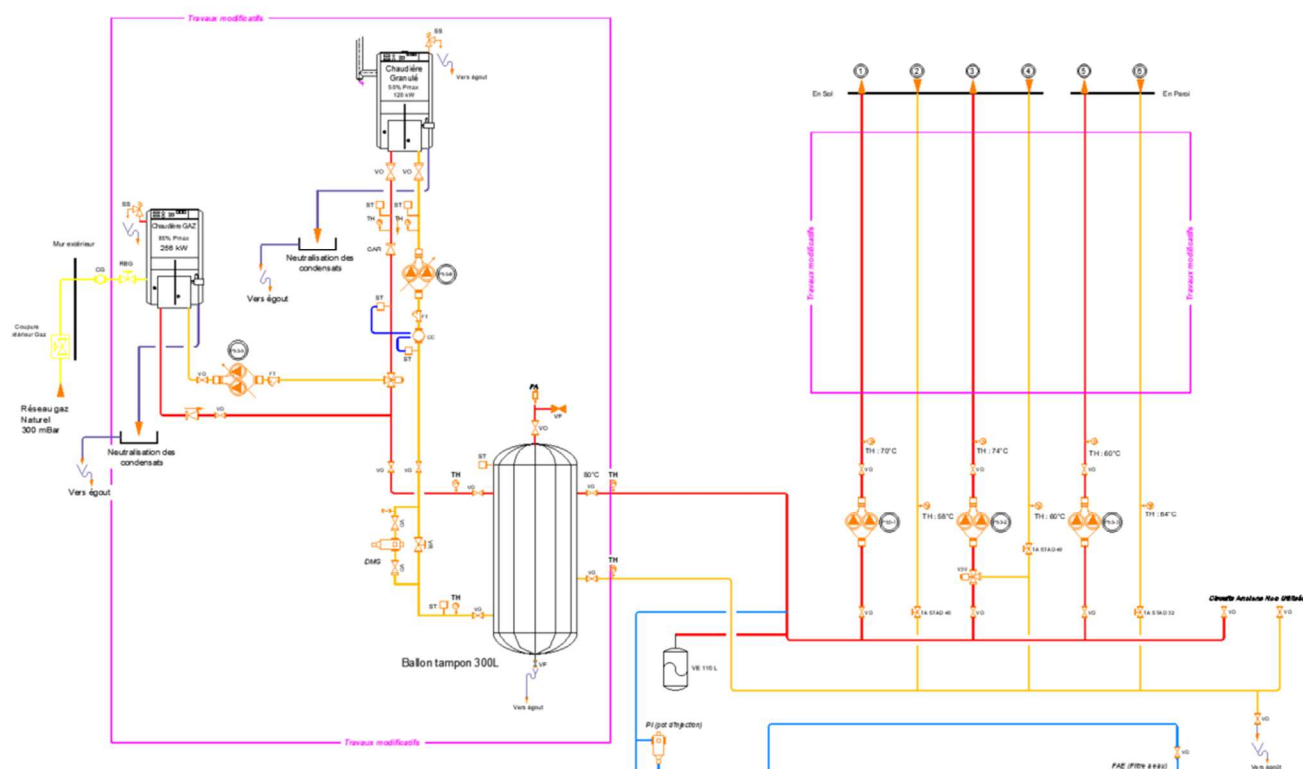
Schéma de principe de la chaufferie 53 : zoom sur les modifications hydrauliques apportées
